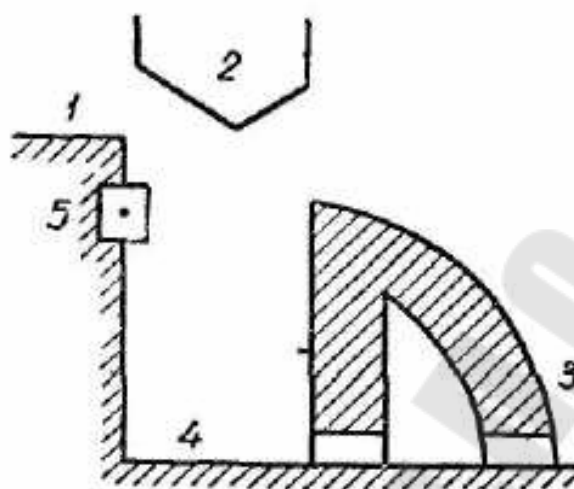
Схема устройства верхних щитовых ворот шлюза
